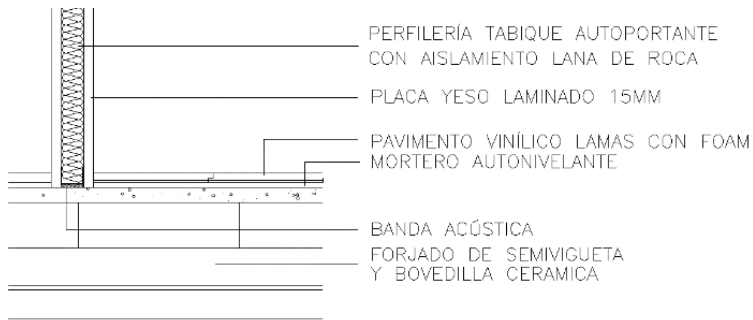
Detalle particiones y pavimento. Fuente propia
